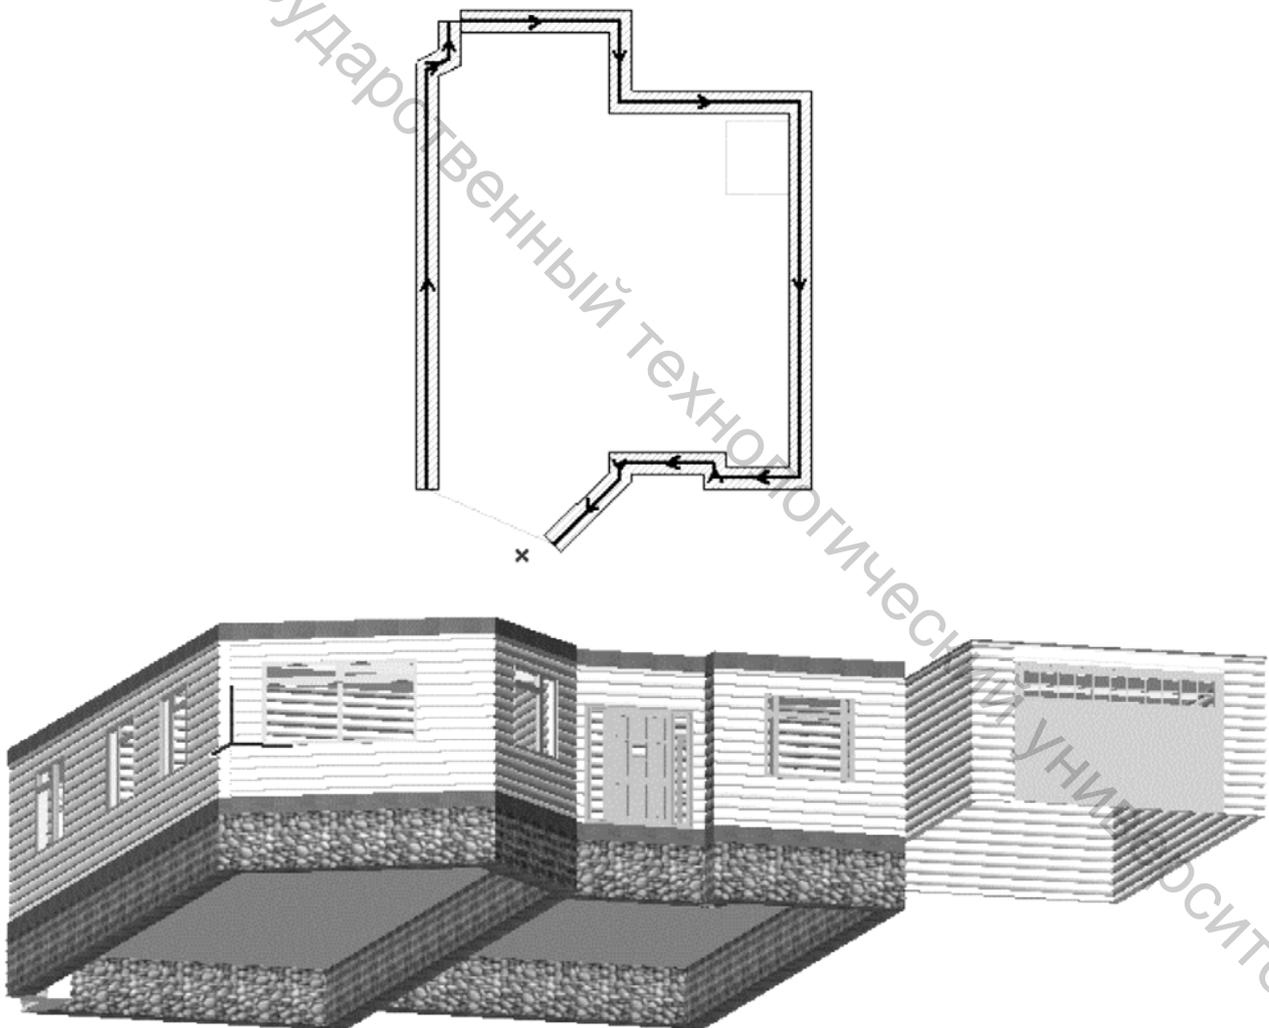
Построение стен фундамента и вид дома с фундаментом и полом
